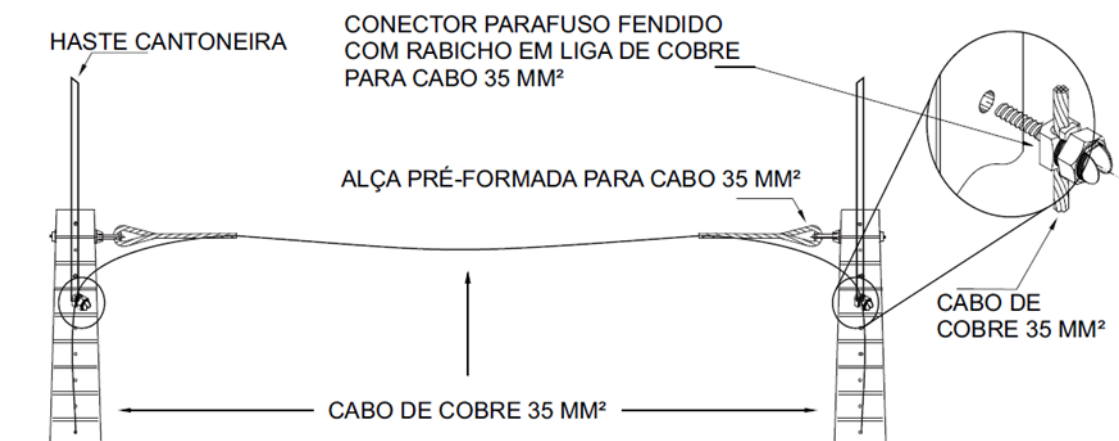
Instalação de cabo como captor fixado em poste com alça pré-formada.
